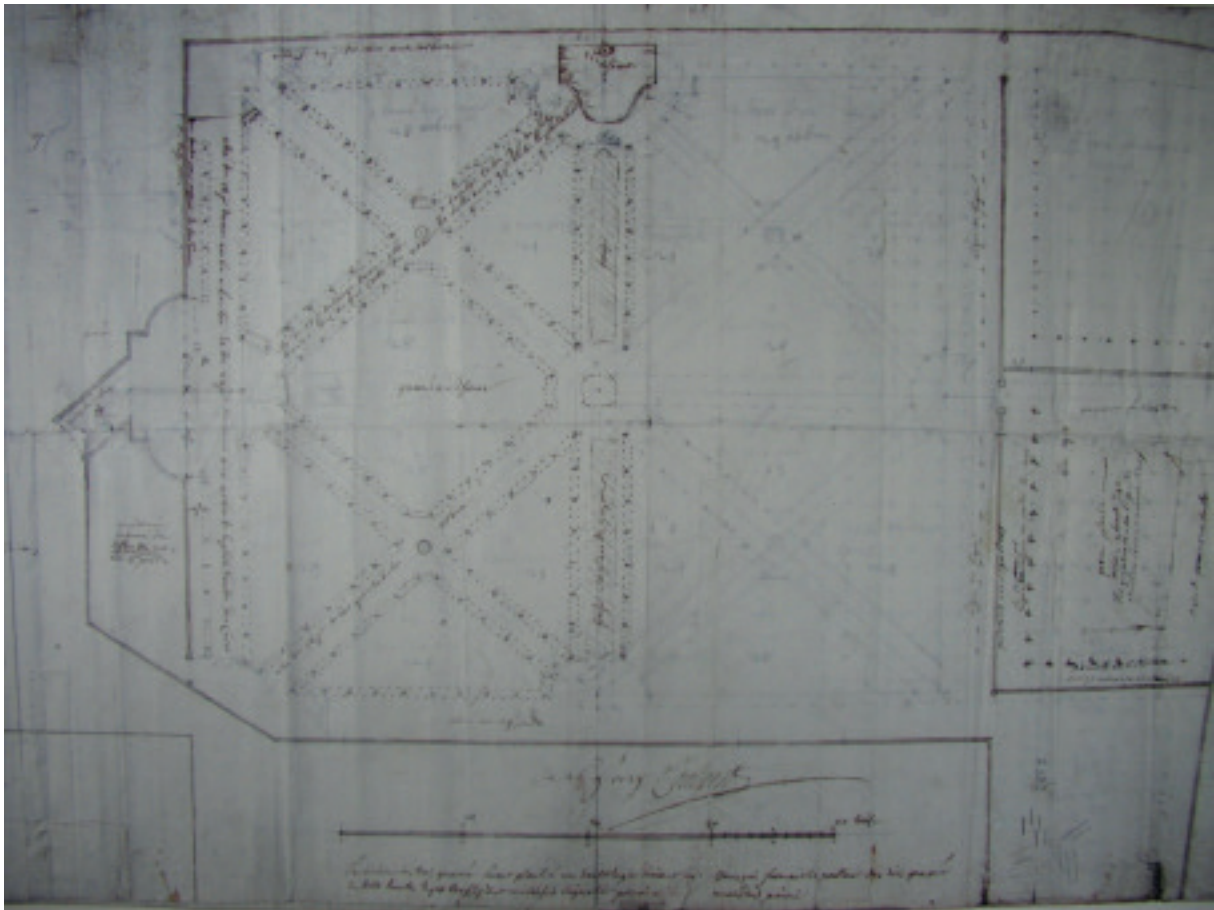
Plan projet de Pierre Contant d'Ivry pour le nouveau potager
